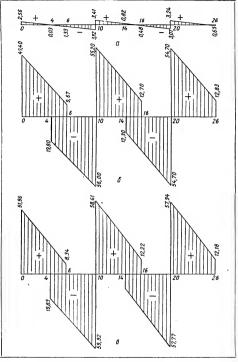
Эпюры расчетных поперечных сил (в m): α — от постоянной нагрузки; δ — от временной нагрузки; δ — суммарная.
